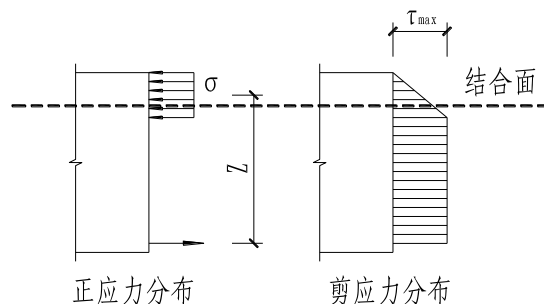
钢筋混凝土受弯构件的截面应力分布示意
